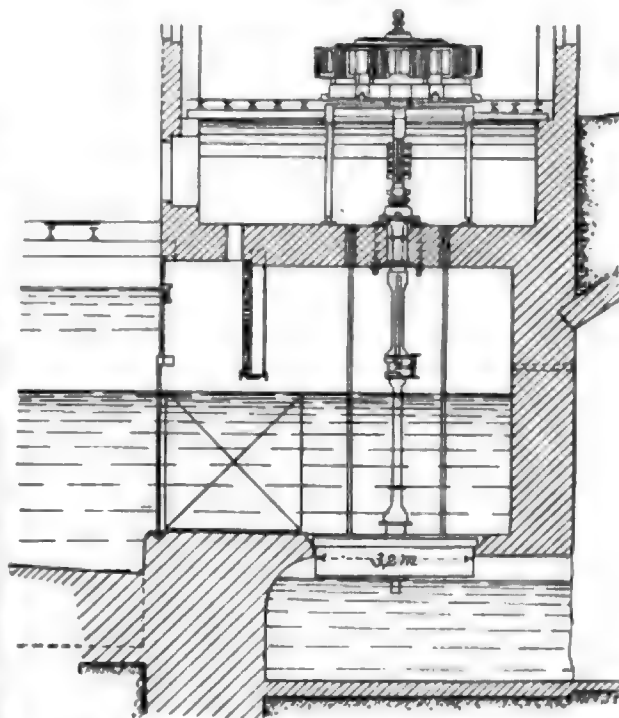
Turbine mit Dynamo im Maschinenhaus.
